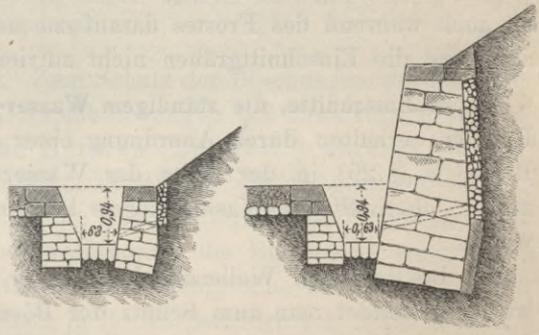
u. 125. Grabeneinfassung mit Mauerwerk an der Brenner-Bahn. M. 1 : 125.
